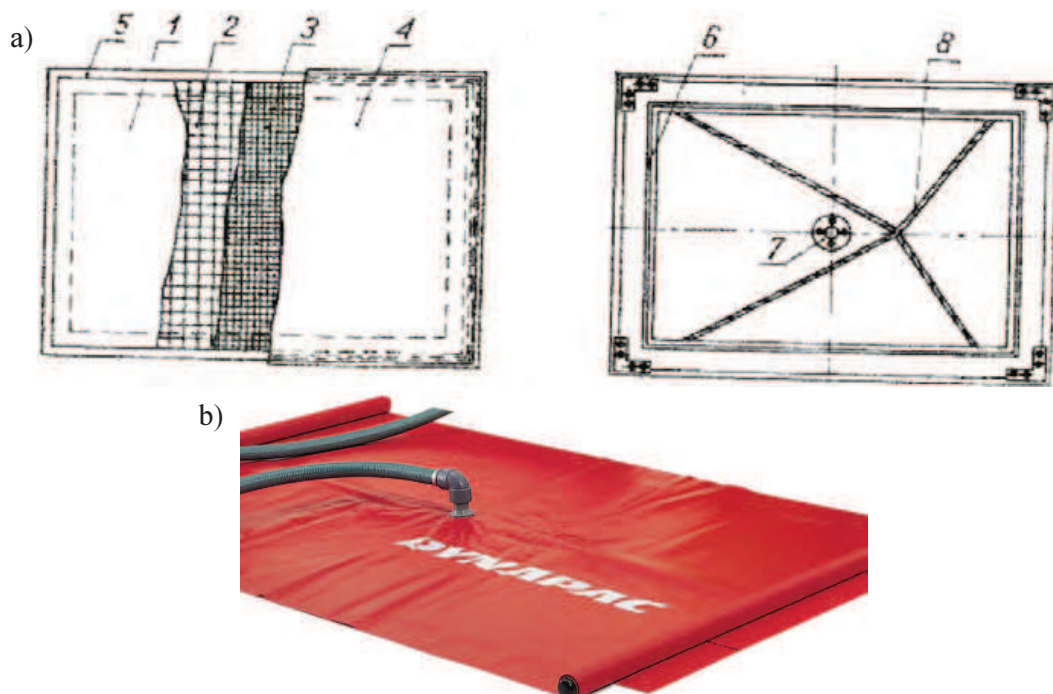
Przykładowe rozwiązania konstrukcji łąt do poprzecznej obróbki powierzchni wykorzystywane po obróbce powierzchni przez listwę wibracyjną [www.concretetfloor.com]
